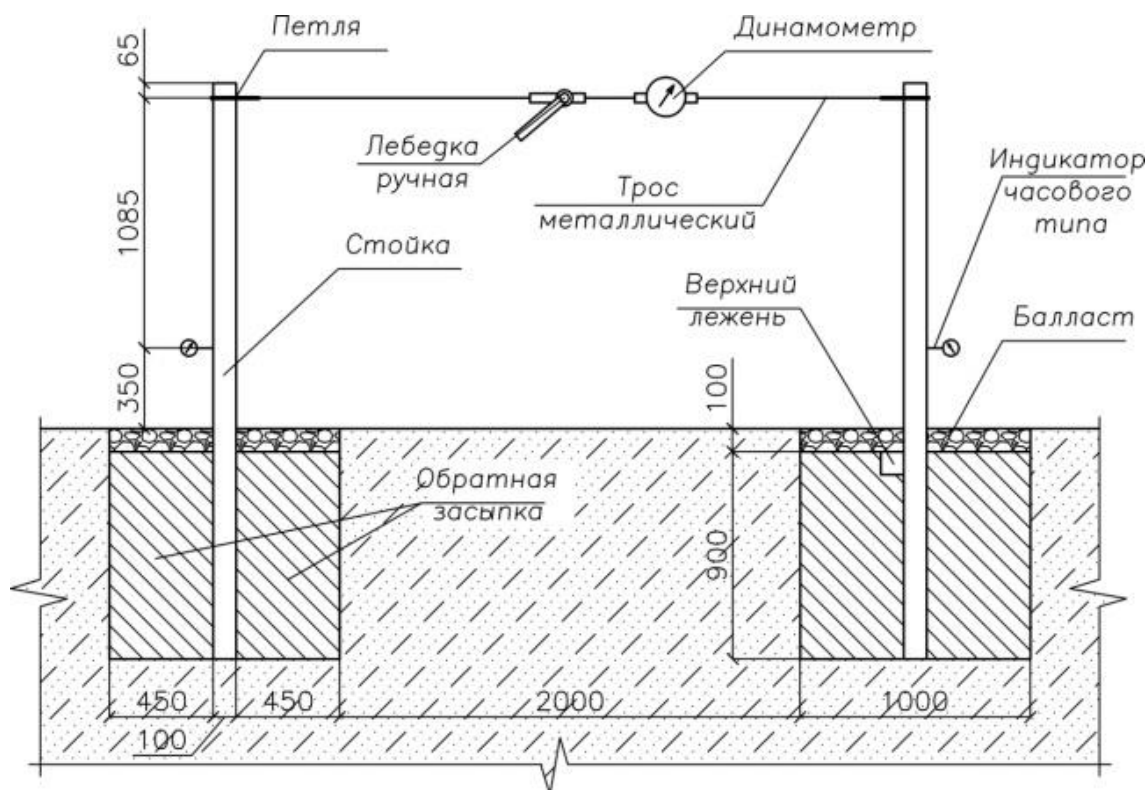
Схема испытаний опор на горизонтальную нагрузку
